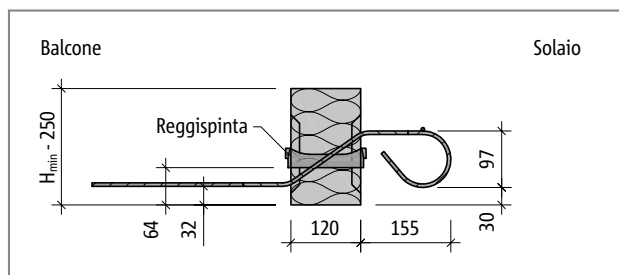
Schöck Isokorb® tipo QXT10 – QXT40: sezione dell'elemento
